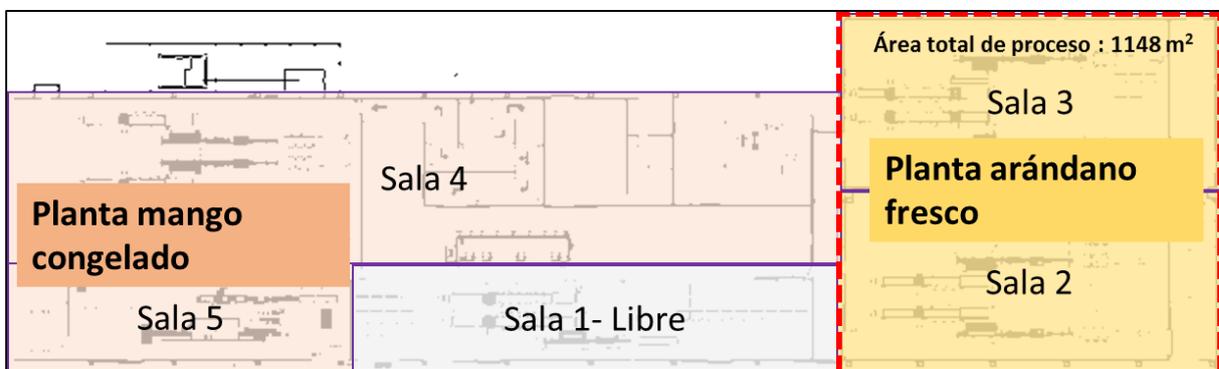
Nuevo layout de la planta de arándano fresco (sala 2 y 3)
